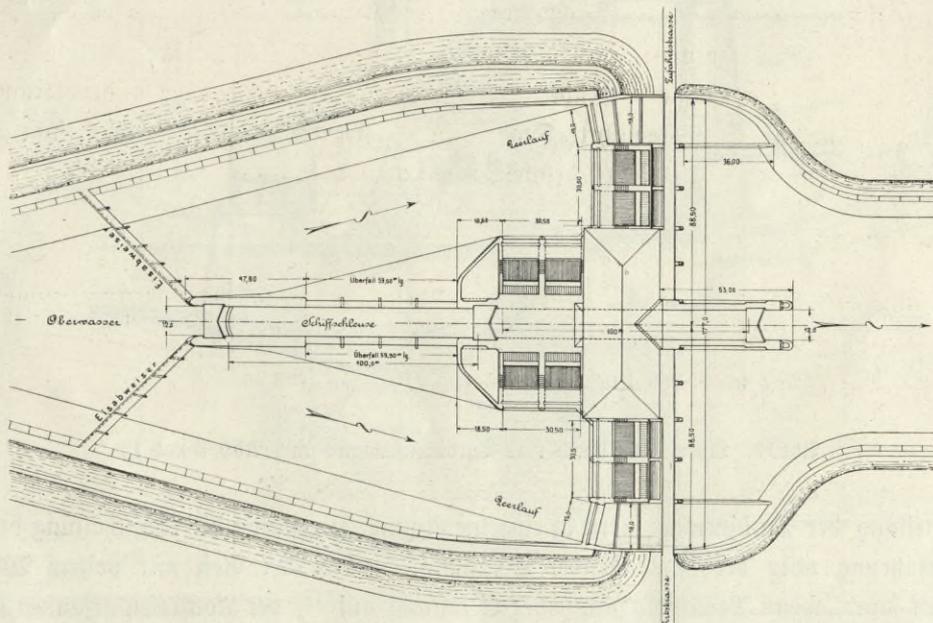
Lageplan eines Kraftwerkes mit rechtwinkelig versetzten Turbinen und mit eingebauter Schiffschleuse
